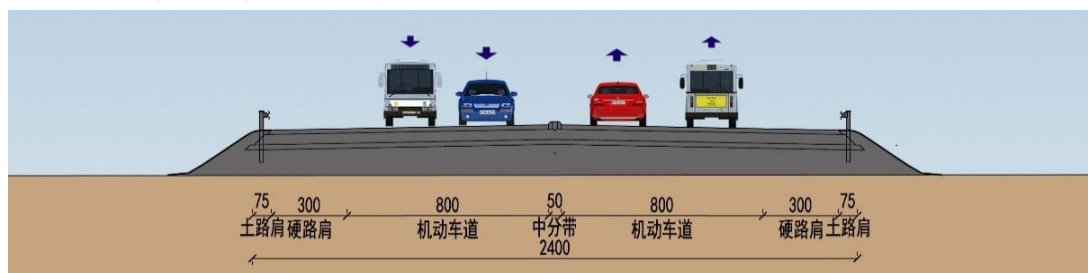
现状 G204 横断面示意图 (G204 交叉口~S232)
